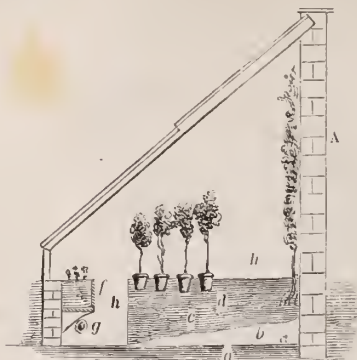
Coupe transversale de la serre Fion à orangers.
